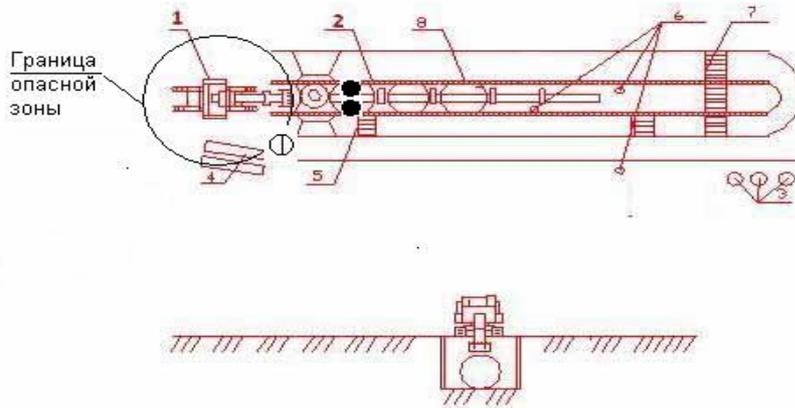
Схема производства работ по укладки стеклопластиковых труб
